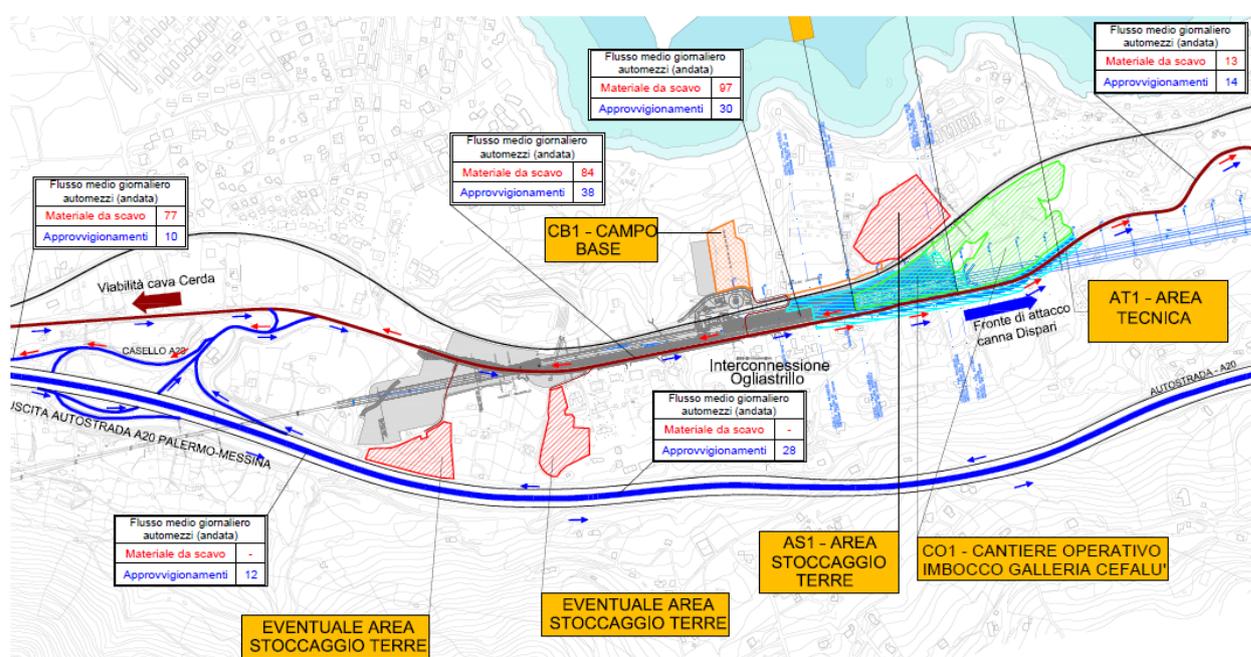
Stralcio planimetria dei flussi area Ogliastrillo
